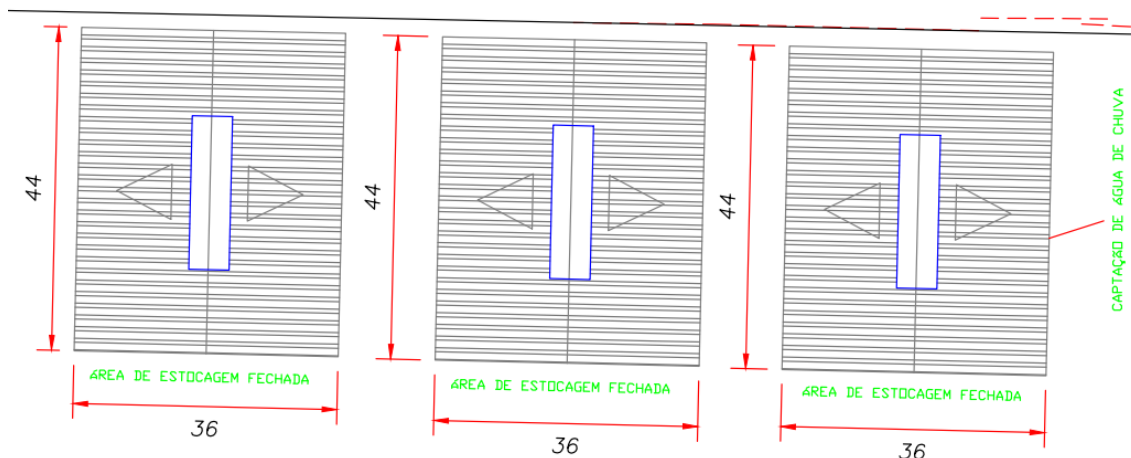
Planta baixa dos Pavilhões de Estocagem
